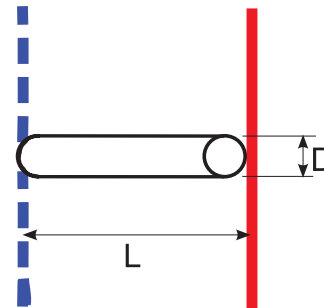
Vue détaillée du by-pass (→ [1] [CS3400iAWS 10 B fig. 33 et 34])
